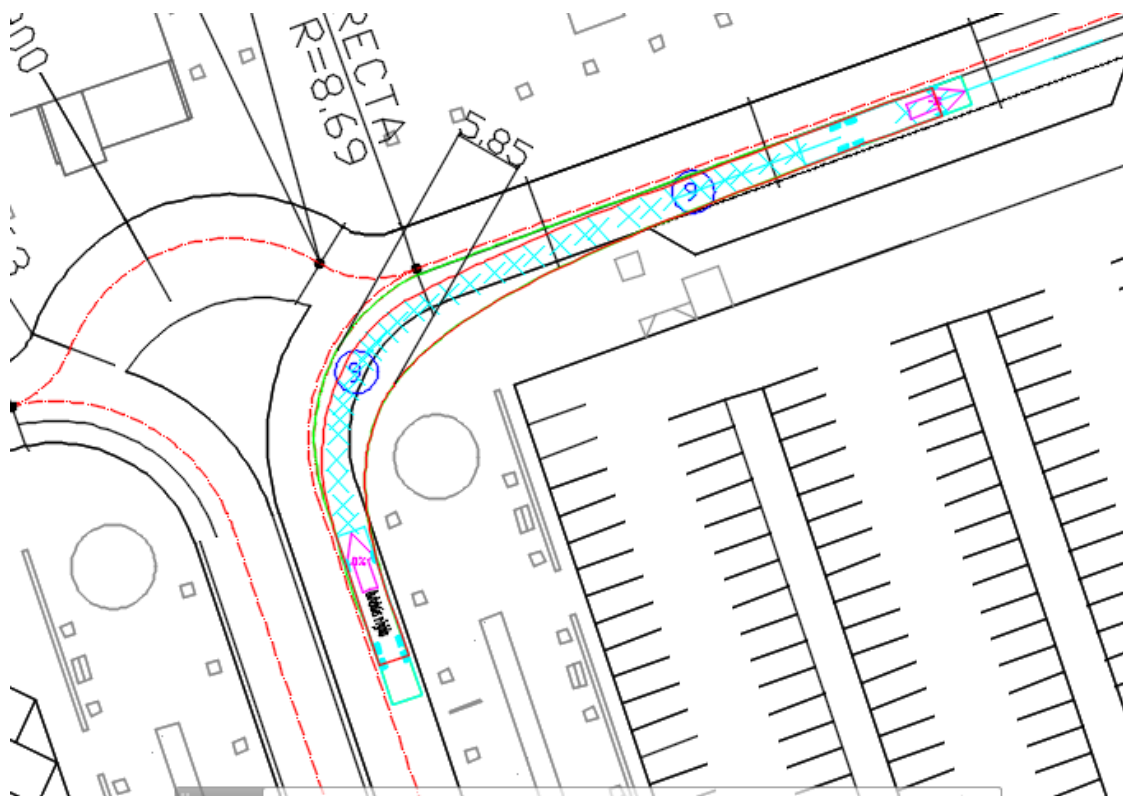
Giro envolvente de autobús rígido en Entrada Acceso Sur. Elaboración propia.
